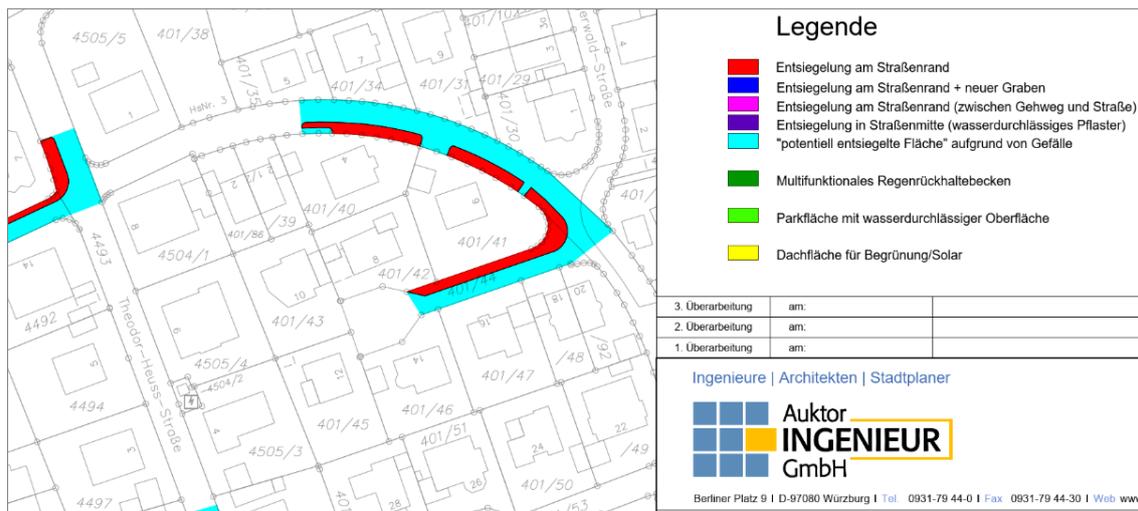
Ausschnitt aus einem Lageplan mit eingezeichneten Maßnahmen [Quelle: Auktor Ingenieur GmbH]
